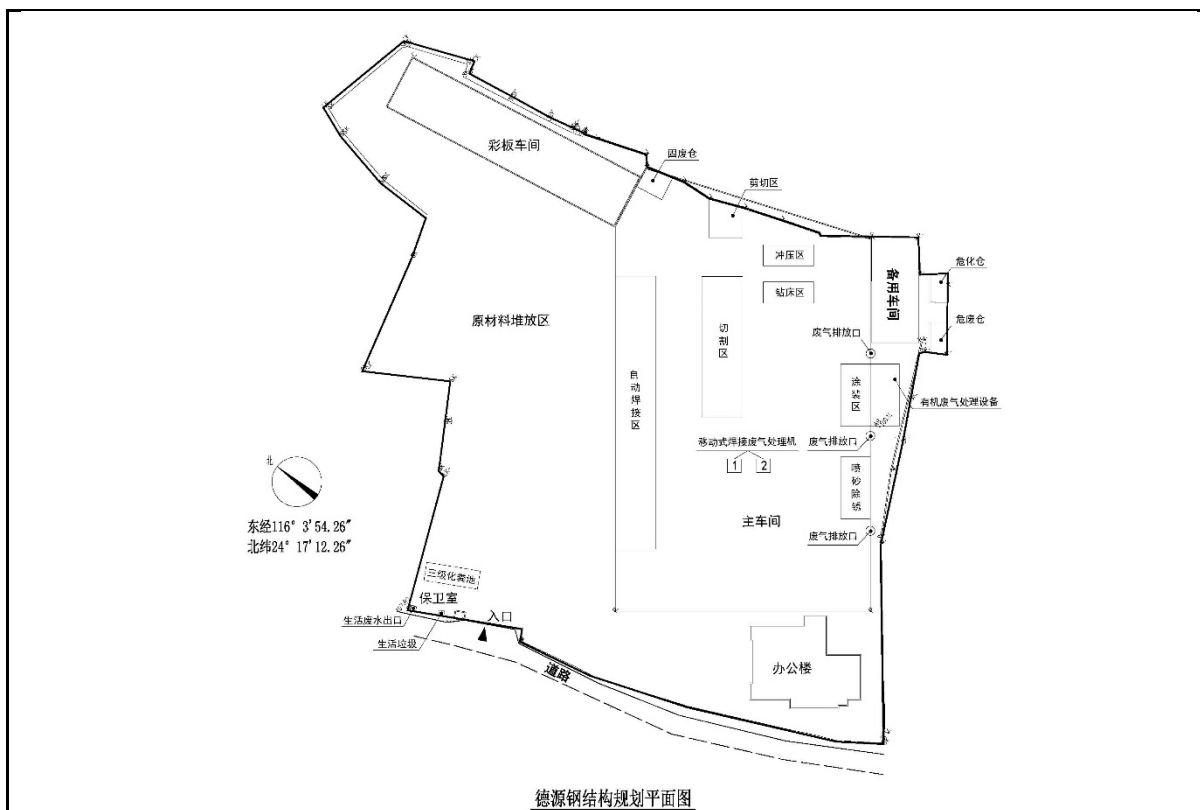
广东德源钢结构工程有限公司厂区平面布置图
